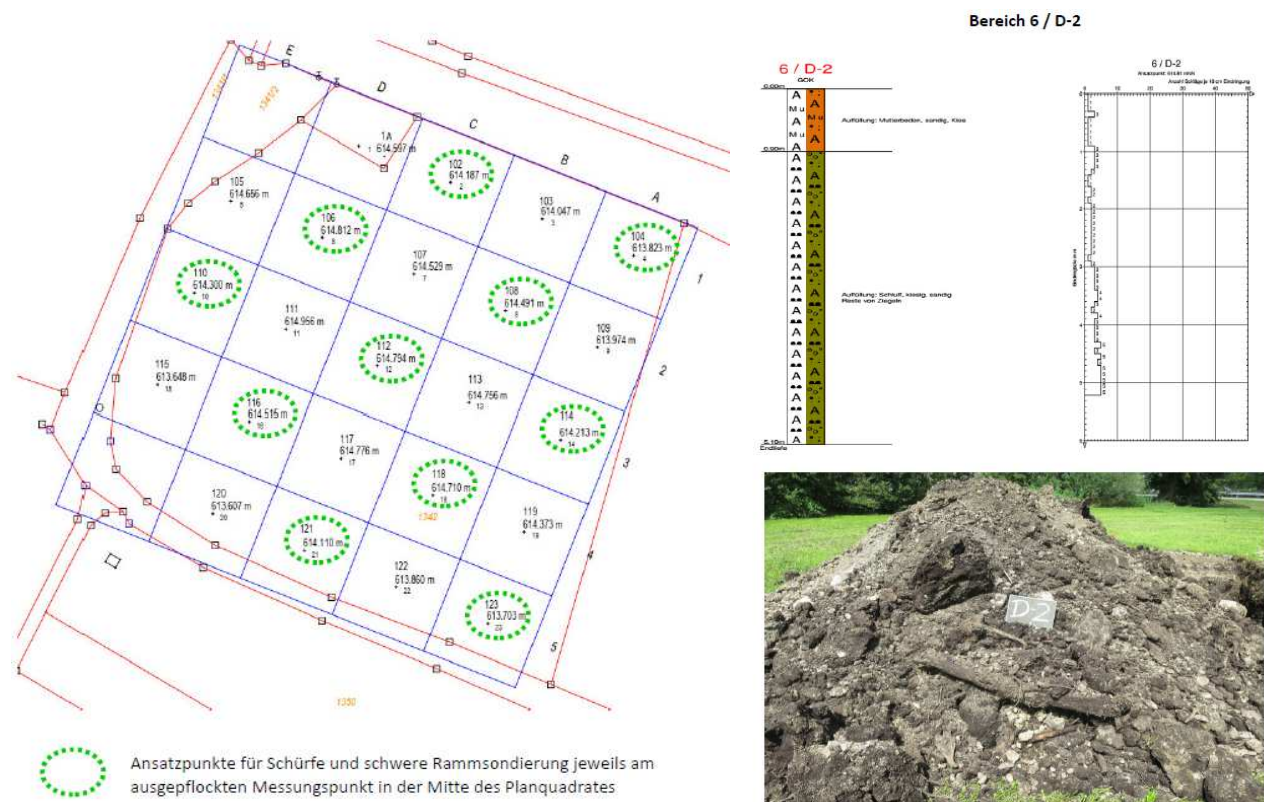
Lageplan zu den durchgeführten Schürfen und ein Beispiel Bodenprofil
